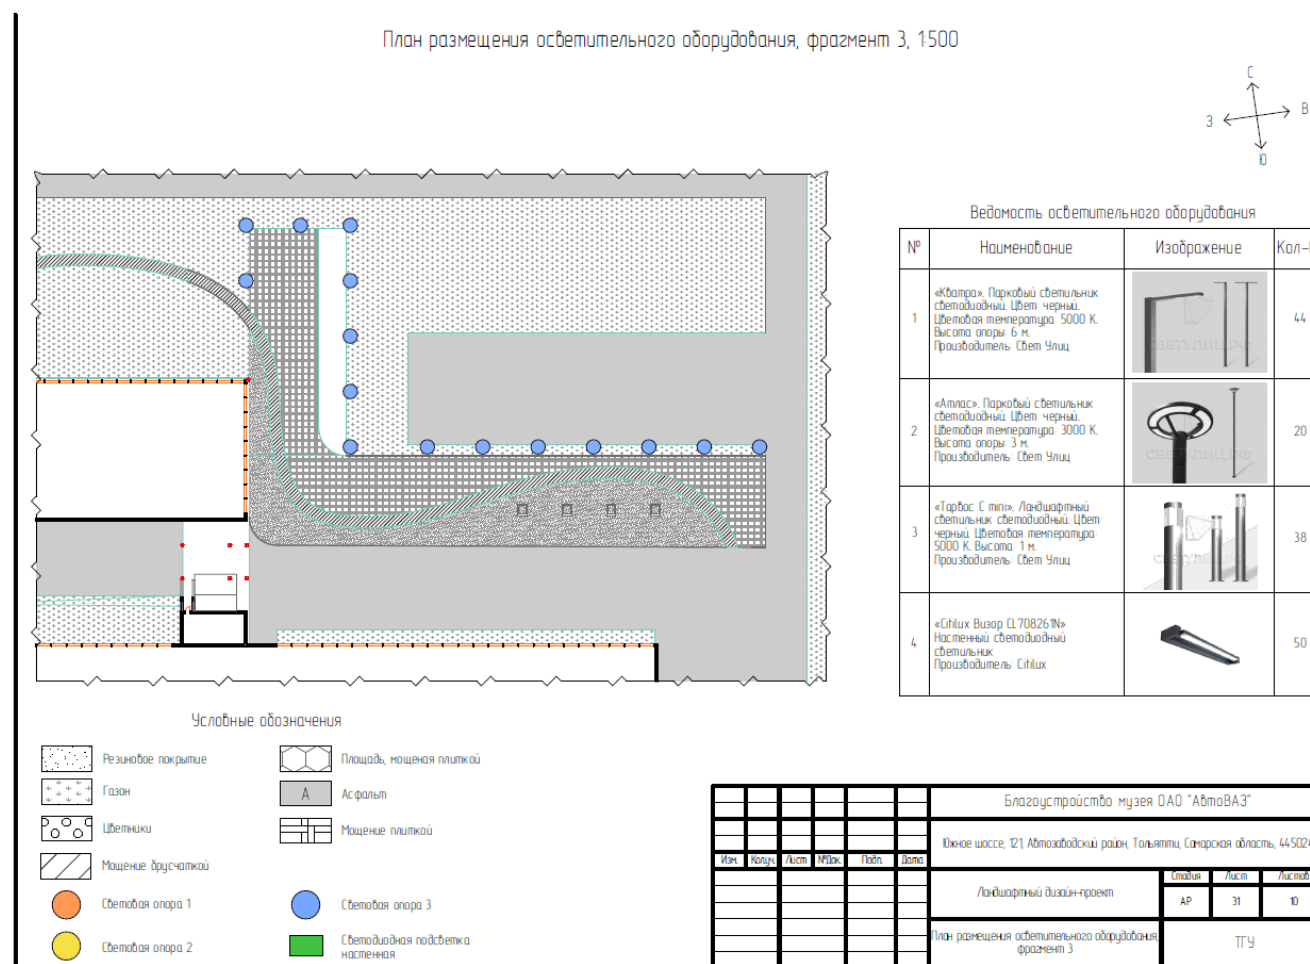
Схема плана размещения осветительного оборудования, фрагмент 3
